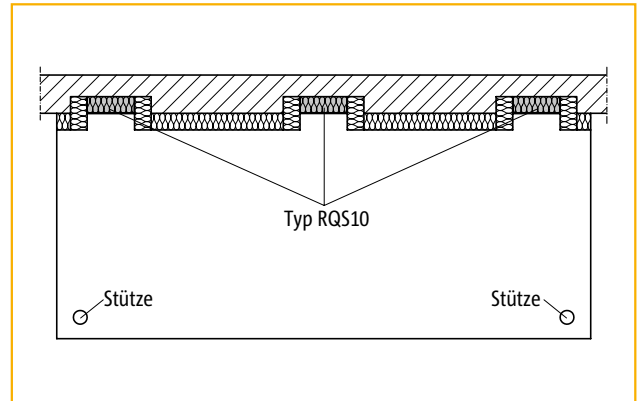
Anschluss eines Balkens an eine Bestandsdecke mit Typ RQS, gestützte Konstruktion
